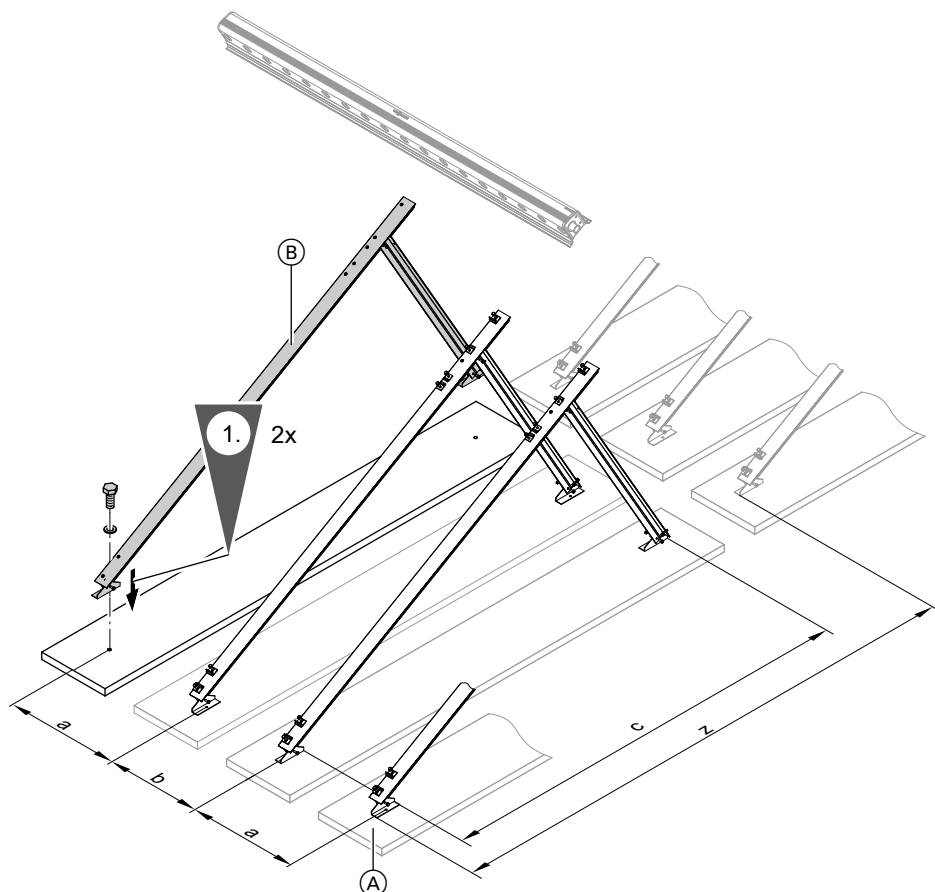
BefestigungsfüÙe als Bohrschablone benutzen.
